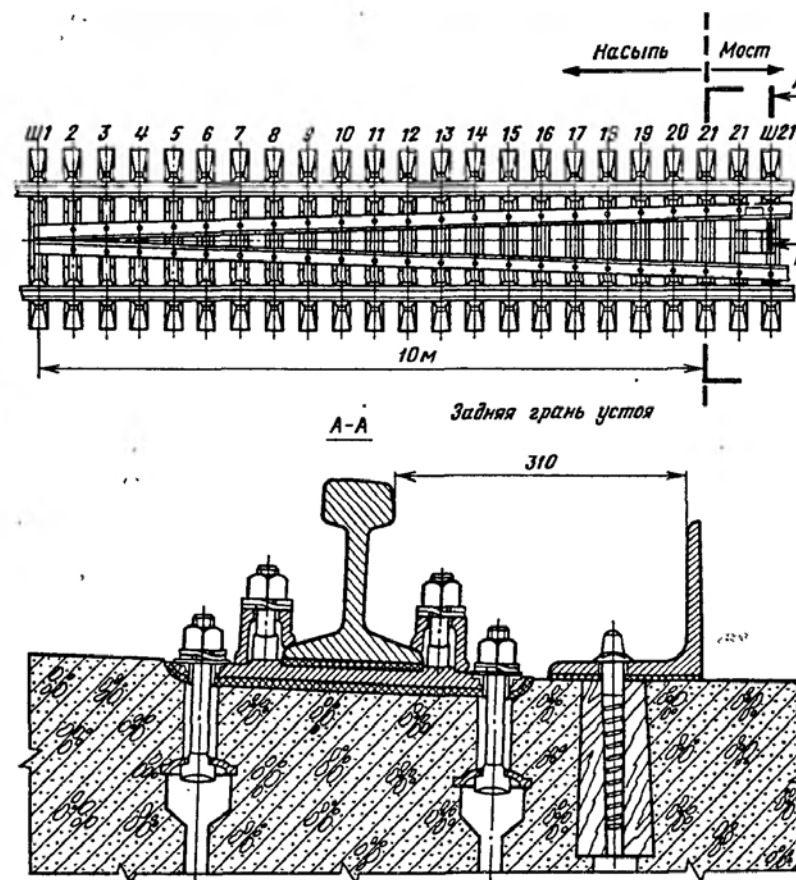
Схема укладки железобетонных шпал в пределах "челноков" (цифрами обозначены типы шпал от Ш1 до Ш21)
